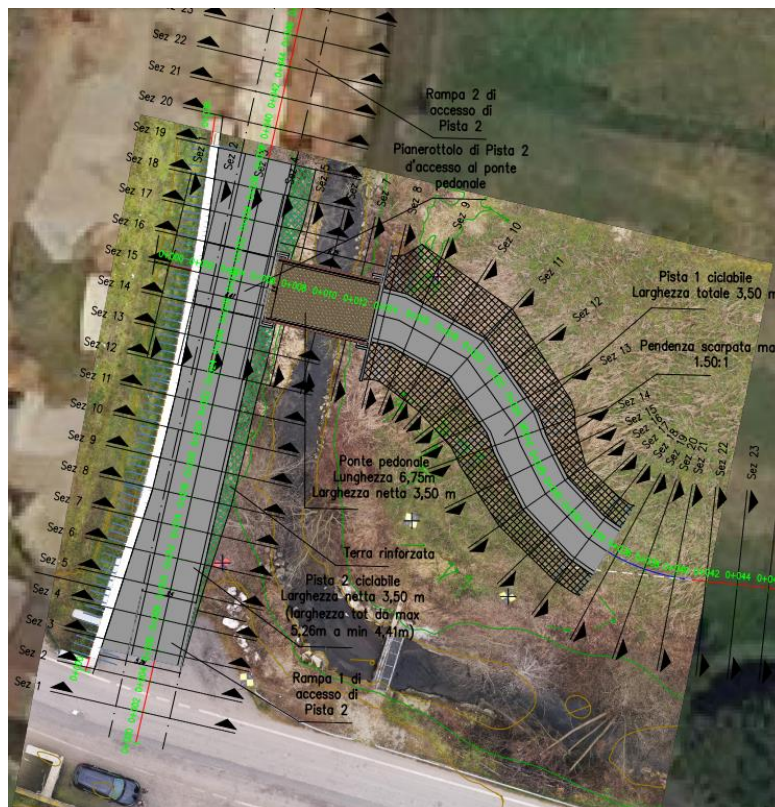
Planimetria del tracciato (locale) – Ponte pedonale 1C
